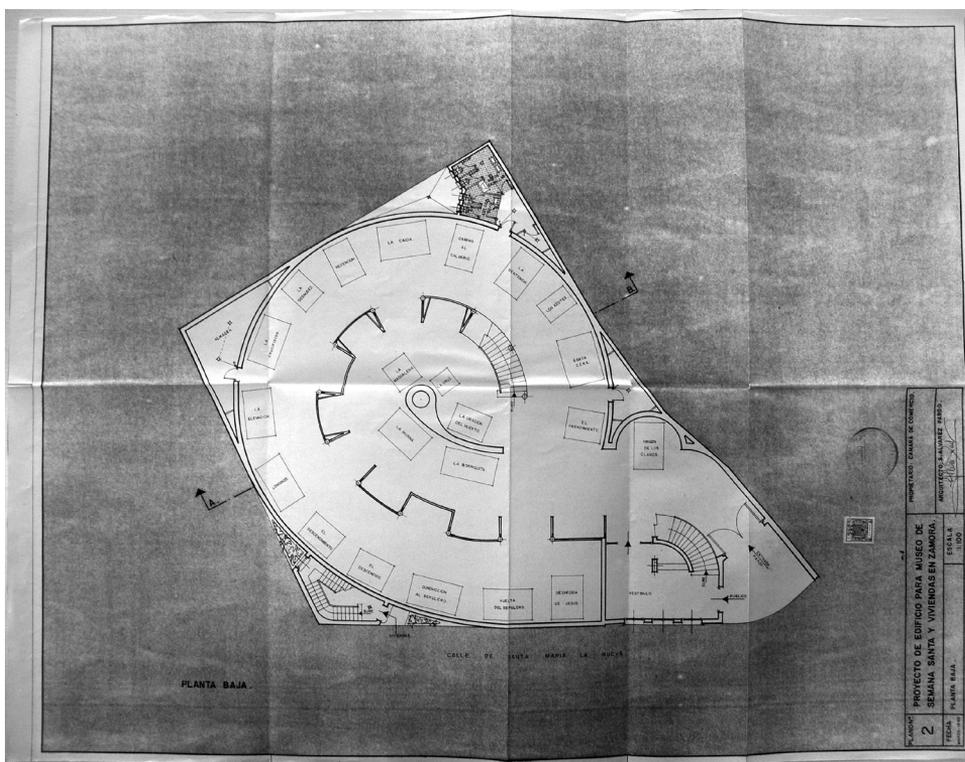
Plano 2, planta baja del museo de Semana Santa. Salvador Álvarez Pardo, 1960.
